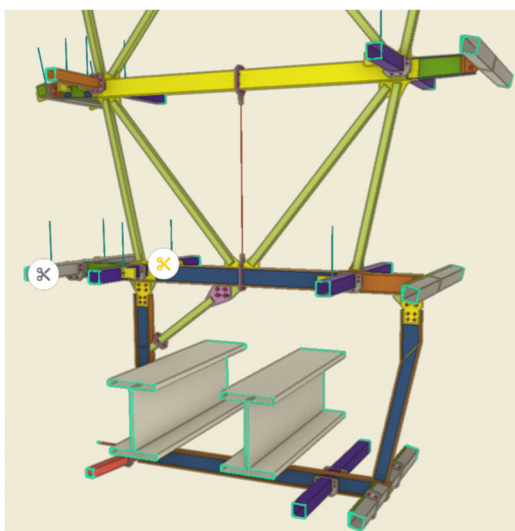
Detalle de “portería” con el tirante inferior de cubierta. Modelo de taller (Horta - Coslada).
